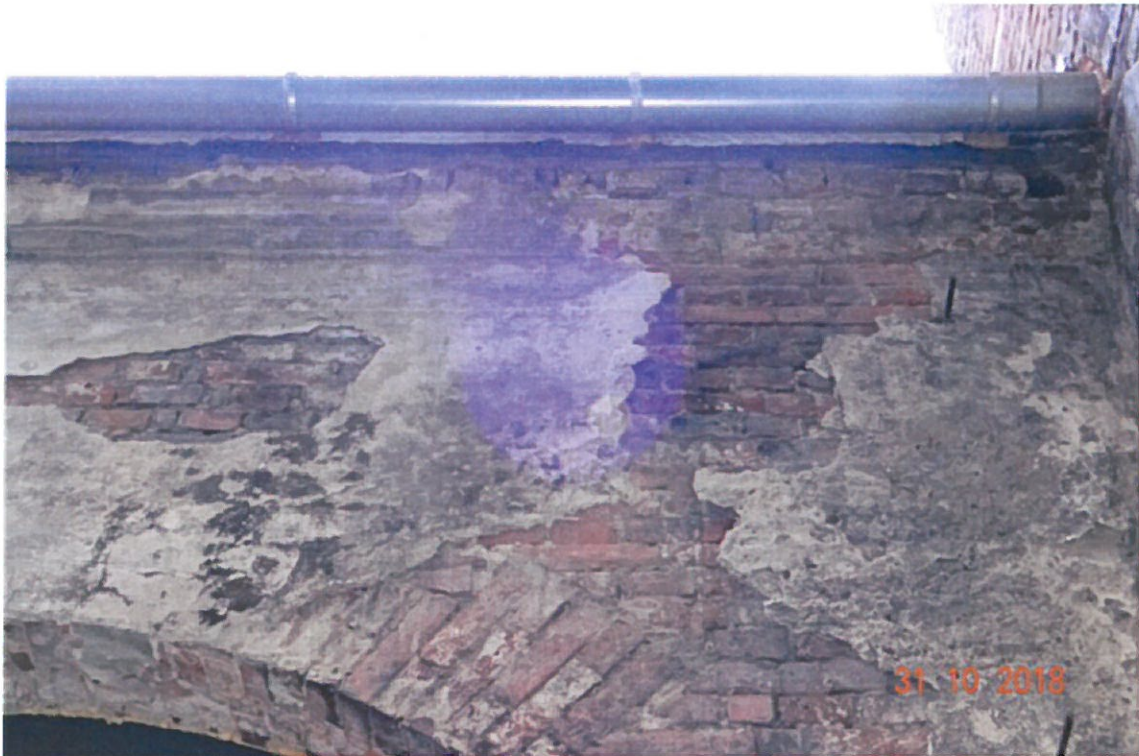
Elewacja frontowa. Widoczne zniszczenie warstwy malarskiej przez krystalizującą sól.
